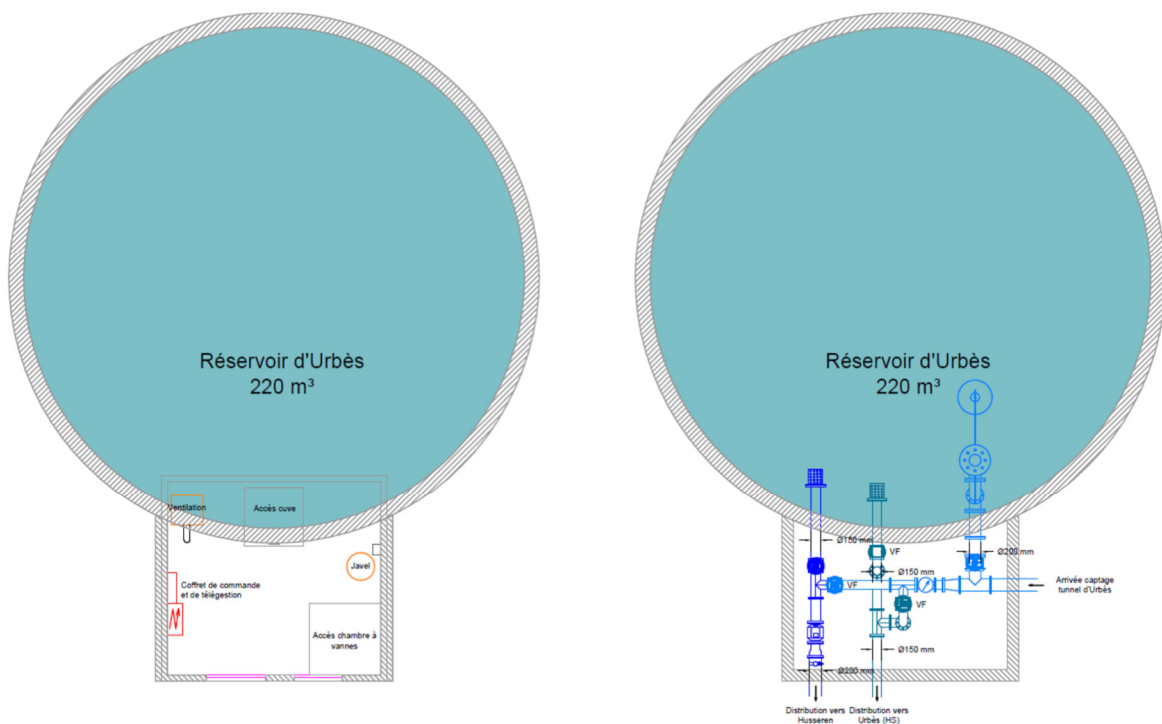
Plan du réservoir d'Urbès (Source : IRH)
